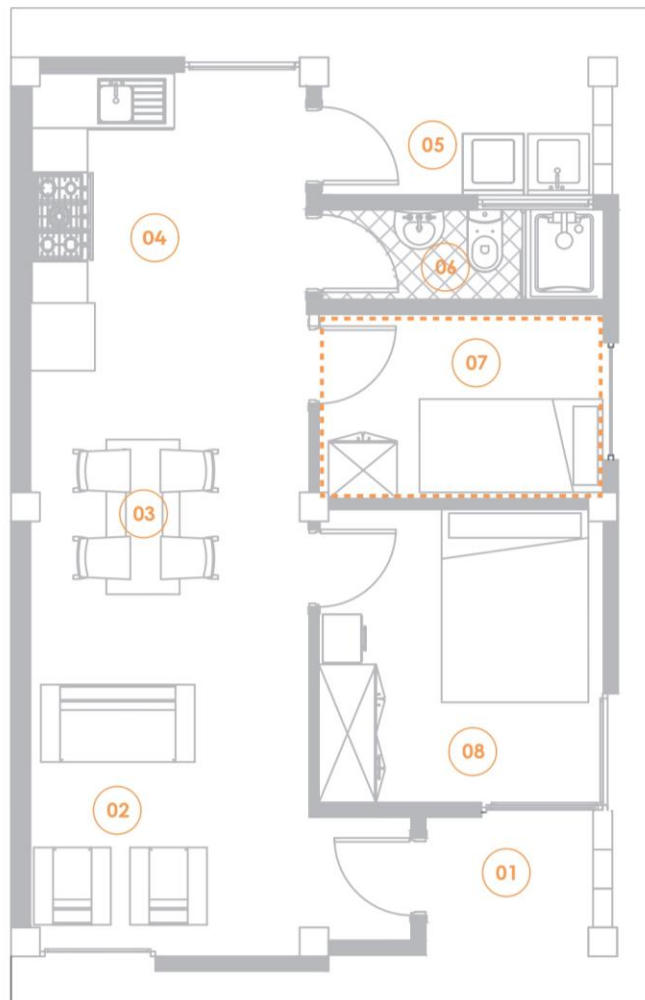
Planta arquitectónica – Alternativa 3 *Nota.* Elaboración propia
